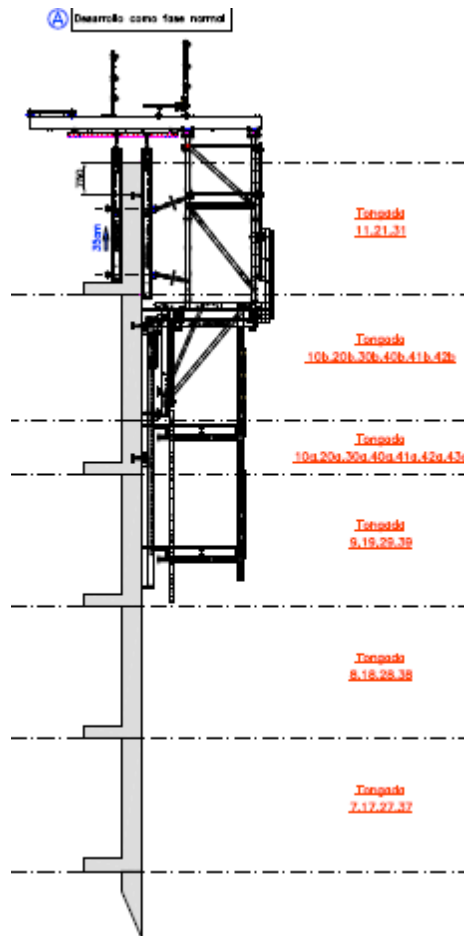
Esquema fase 4,5 y 6ª trepado planta técnica.2005.Doka
